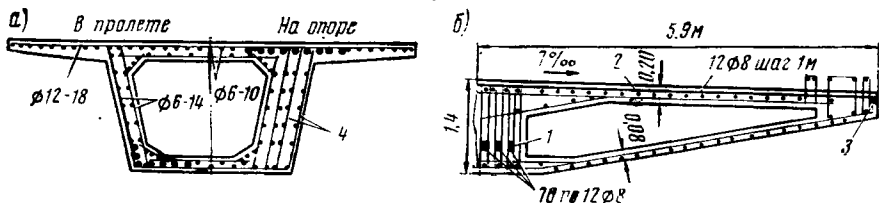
Схема расположения арматуры в коробчатых поперечных сечениях: 1 — продольная напрягаемая арматура; 2 — поперечная напрягаемая арматура плиты проезжей части; 3 — натяжной анкер; 4 — хомуты
